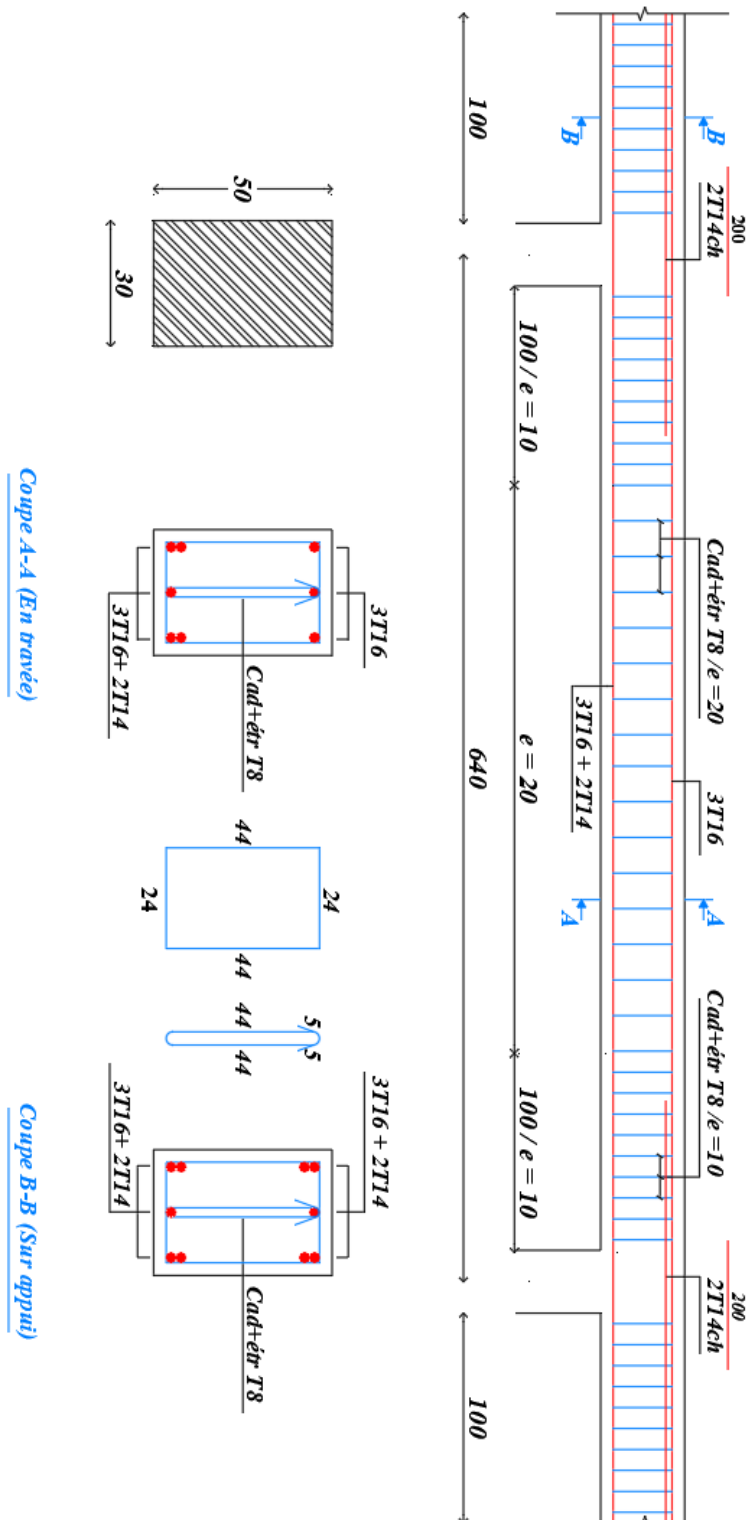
Schéma de ferrailage des poutres principales Axe :1-2-4
